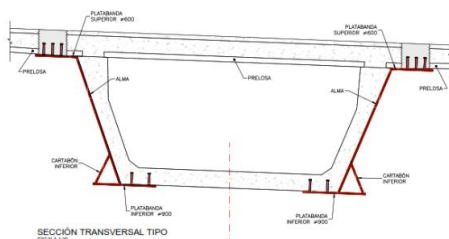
Sección de viga artesana con refuerzo externo metálico, incluyendo conectores en tablero y fondo de viga.
